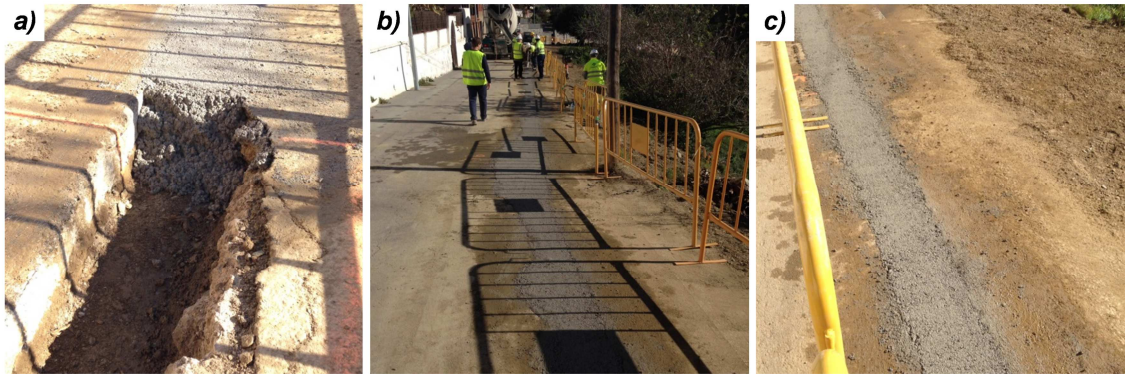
119 – a) capa de hormigón de 20cm; b) detalle de zanja hormigonada; c) aspecto de la zanja acabada
